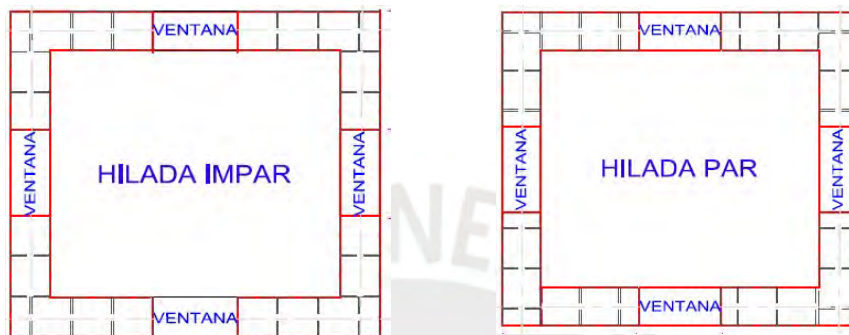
Distribución de adobes en planta para hiladas par e impar (Pando, 2017)
